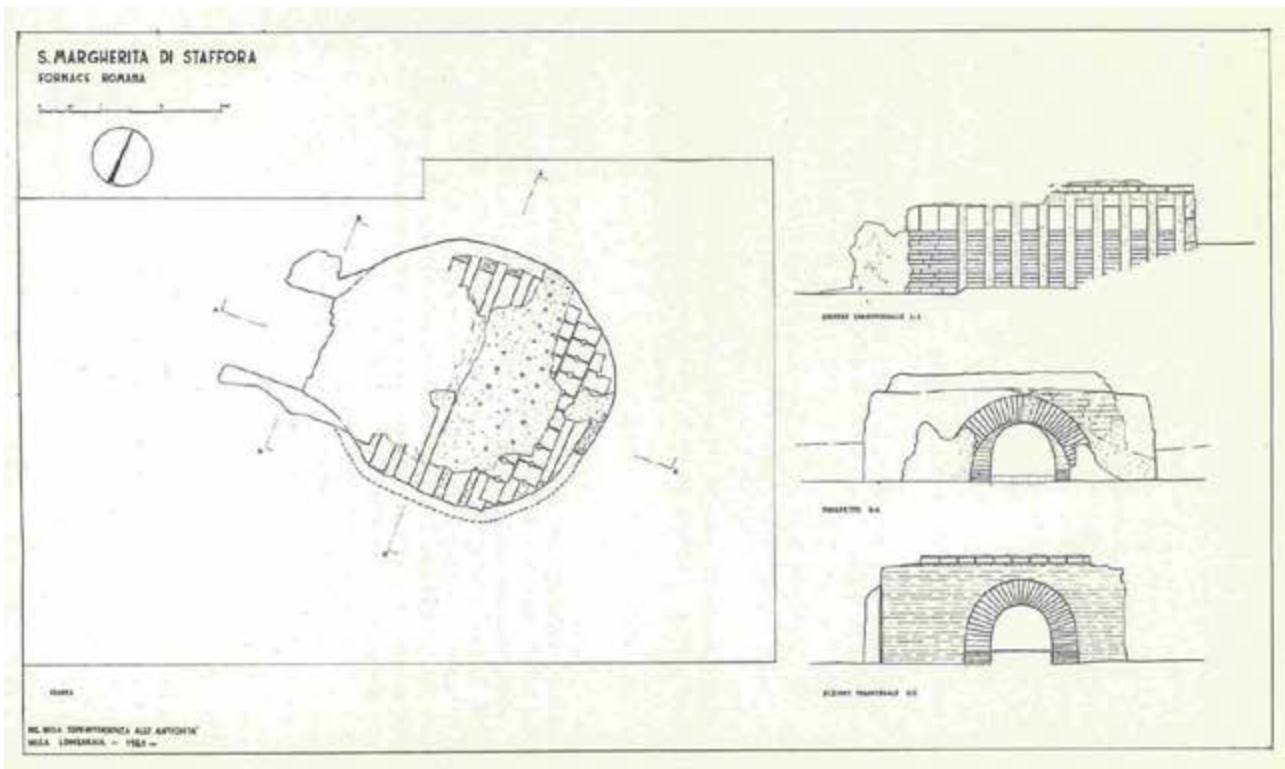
Pianta, prospetto e sezioni della struttura della fornace al termine dello scavo (da PACE 1961).
